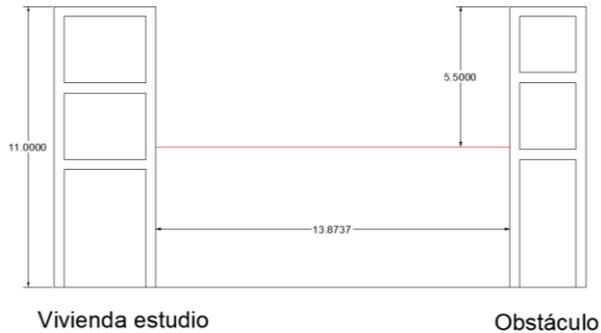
Elevación del obstáculo, patrón de sombras, fachada este. 2016. López, L.
